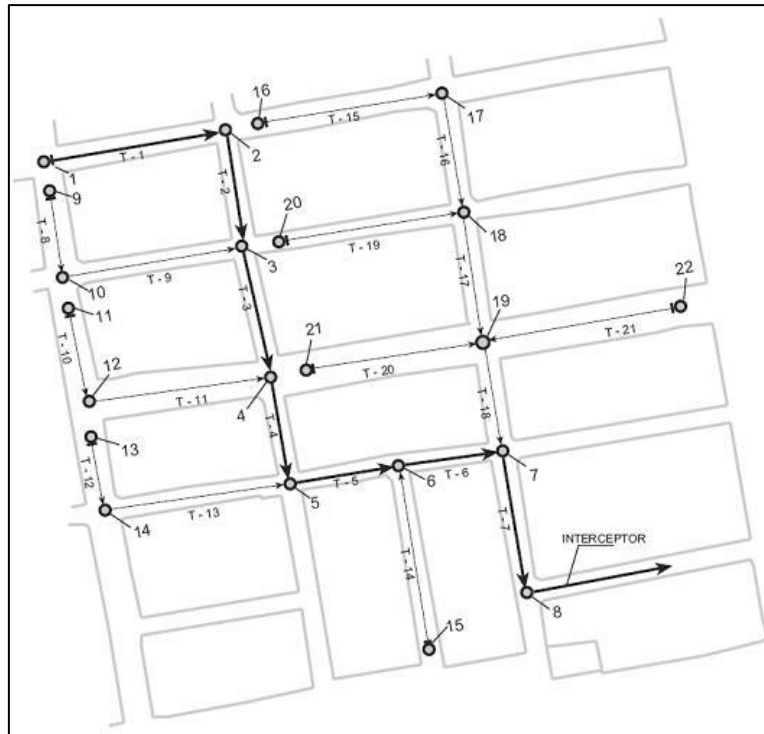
Distribución en planta típica de un alcantarillado sanitario convencional
